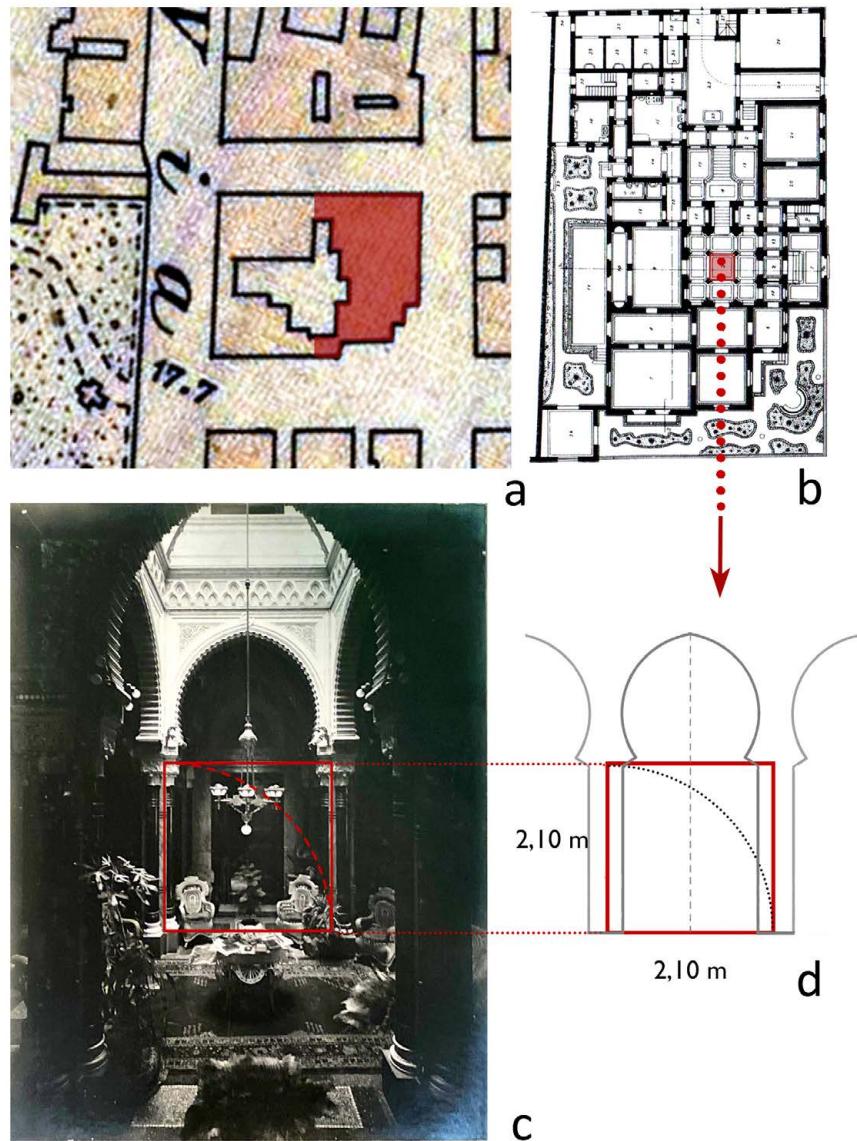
a) stralcio planimetrico con individuazione del lotto della villa Bonanno; b) riferimento planimetrico con evidenziato lo spazio interno della sala; c) schema del quadrato nella relazione tra larghezza e altezza della campata centrale; d) dimensionamento del quadrato e relazione con il profilo dell'arco. Elaborazioni degli autori.
